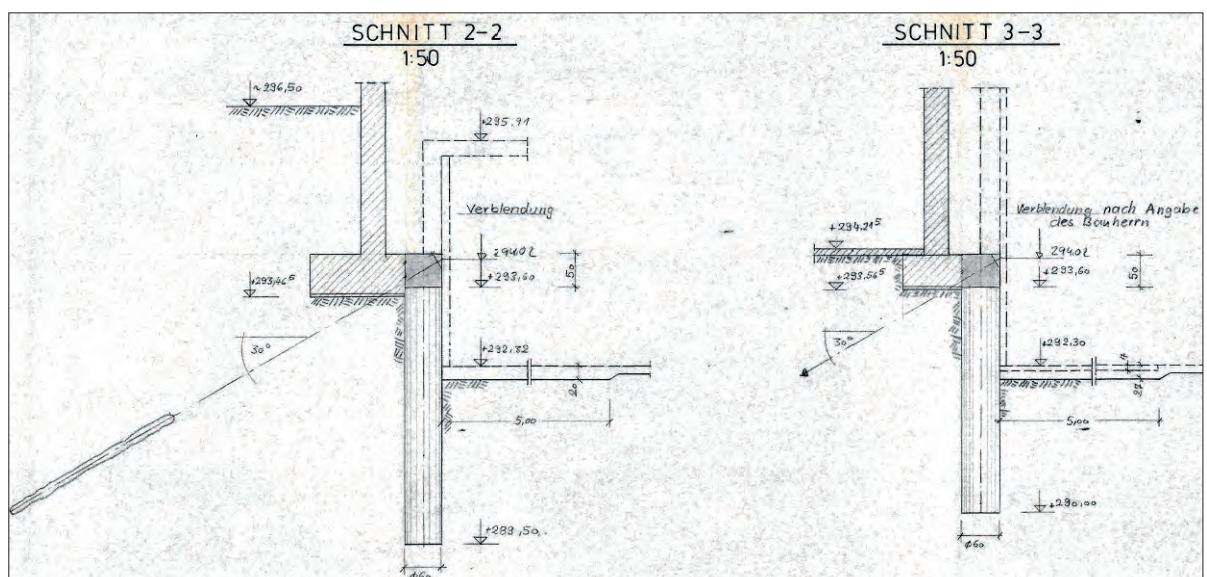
Lageplan und Schnitte mit Angaben zur Verankerung und zum Verbau/Bilfinger + Berger Bau AG (Auszug) [15c]
